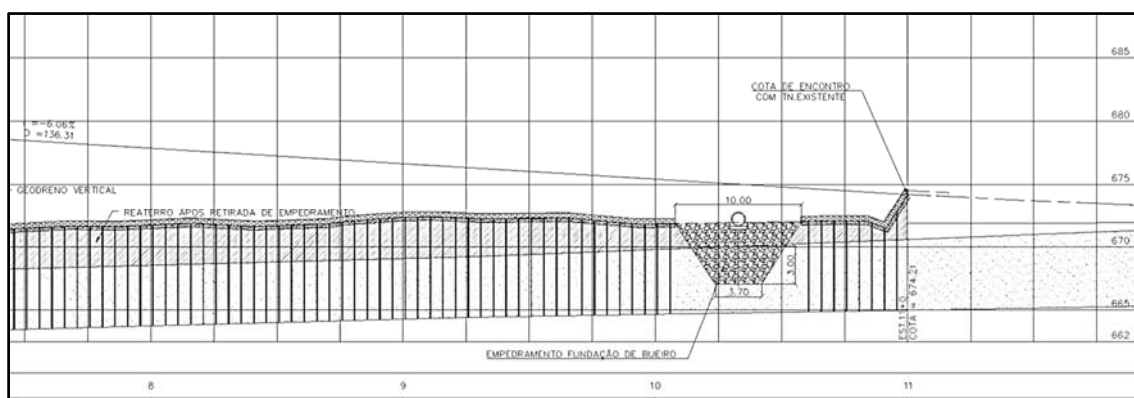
Empedramento na fundação do bueiro BSTC Ø 1,00 m estaca 10 + 6,58 e aplicação de geodrenos para adensamento do solo mole.
